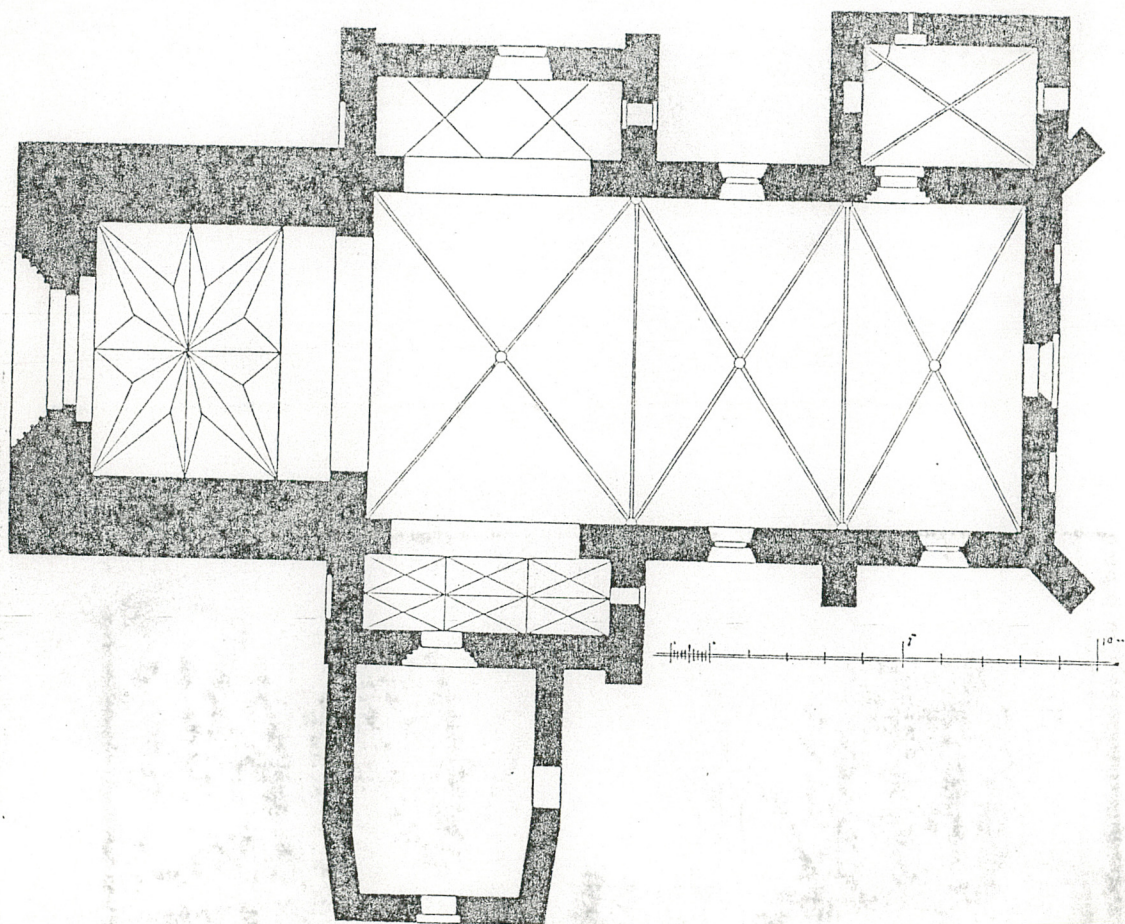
Grundriß der Pfarrkirche in Pettelkau.
